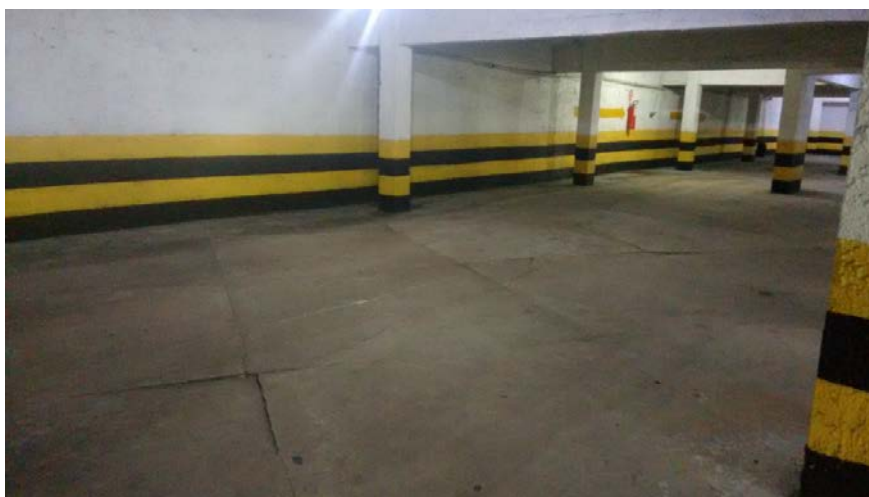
Área 2 com pontos de elevação de placas no subsolo -2
